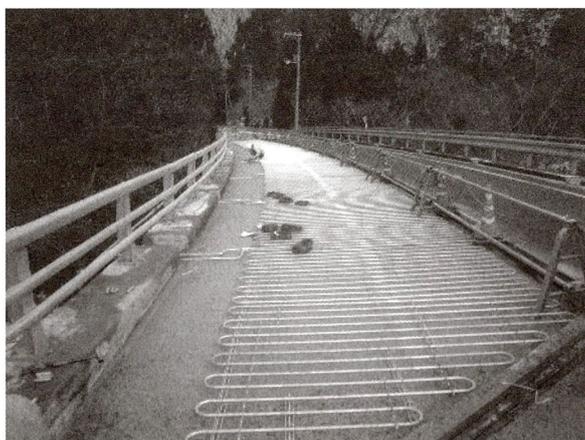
橋梁部のパイプヒーティングパネル設置状況
